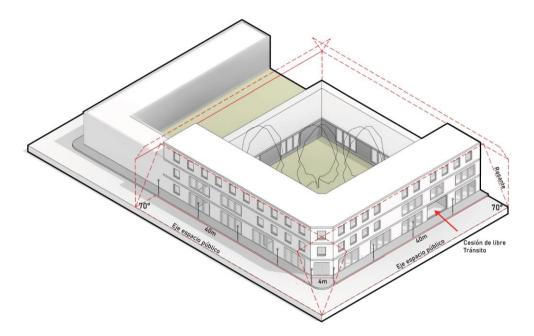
Imagen referencial de la zona ZU-1 Zona Centro con incentivos
